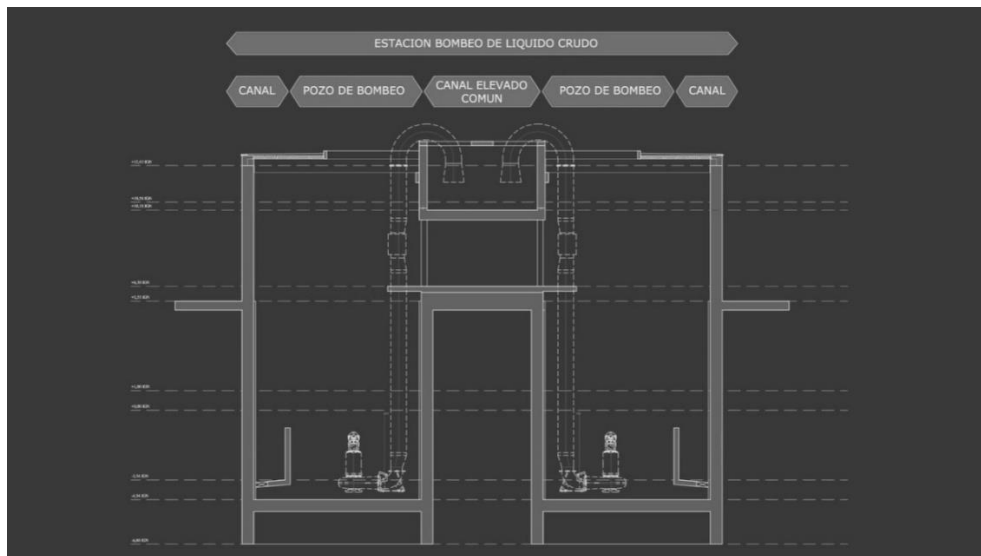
Plano estación elevadora de líquido crudo. Fuente de elaboración COARCO, 2017
